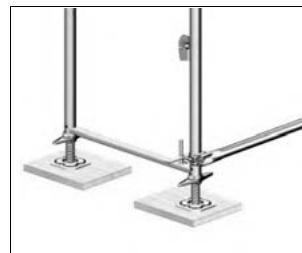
Last verteilender Unterbau mit Holzbohlen
